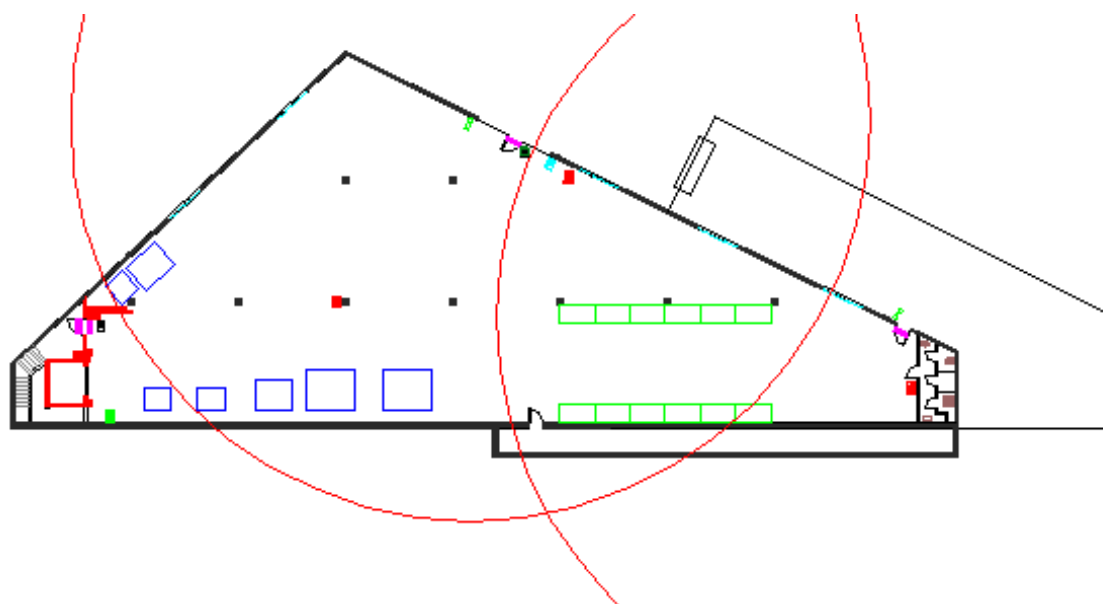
Superficie cubierta por los pulsadores en la planta baja del edificio Oficinas
